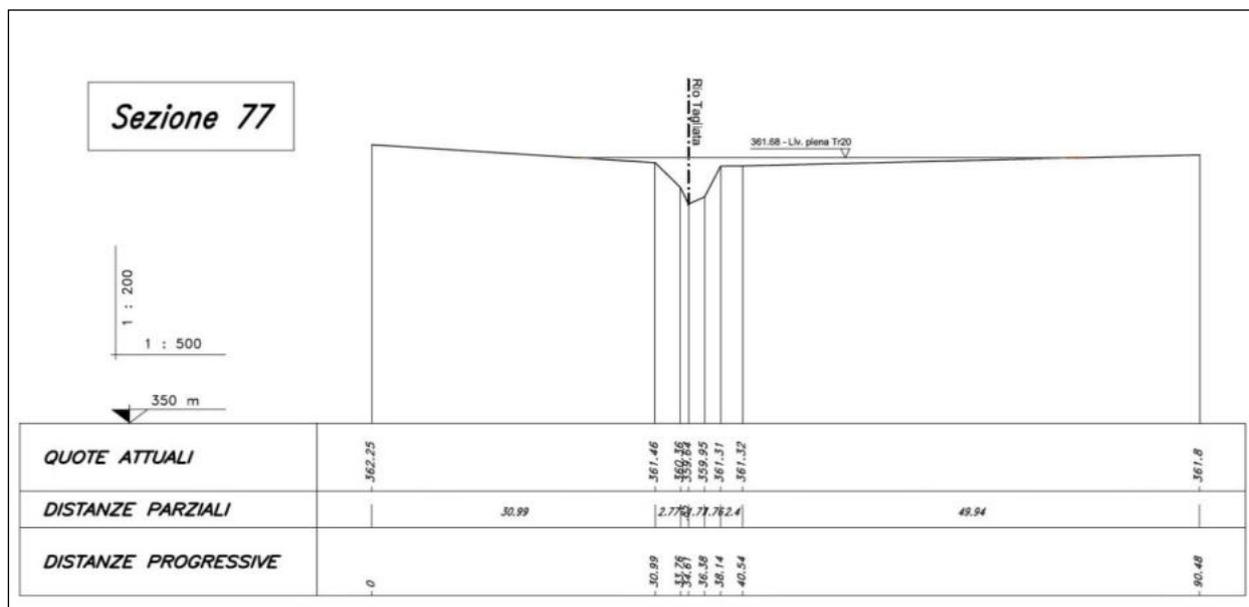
/17 – Sezione di esondazione con TR_{500} , circa 100 m a S dell'attraversamento
